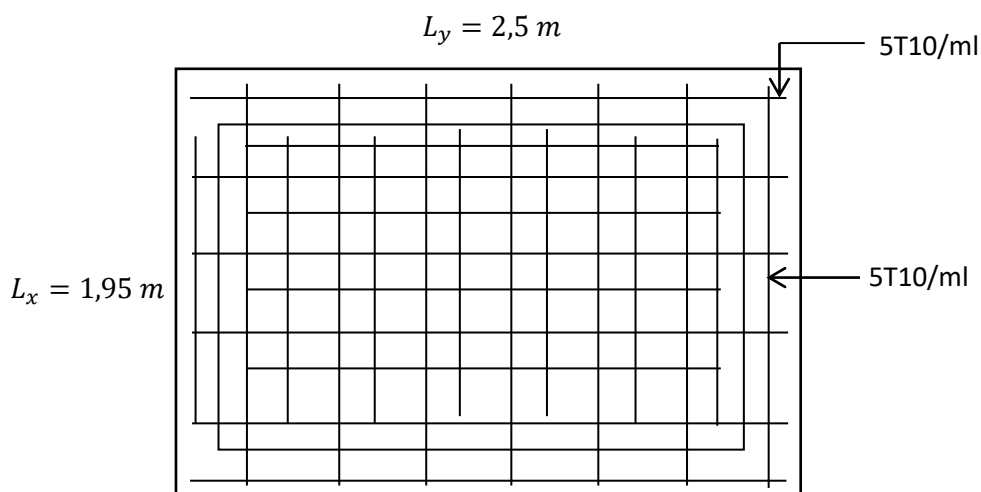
Ferrailage inférieur de la dalle de l'ascenseur
